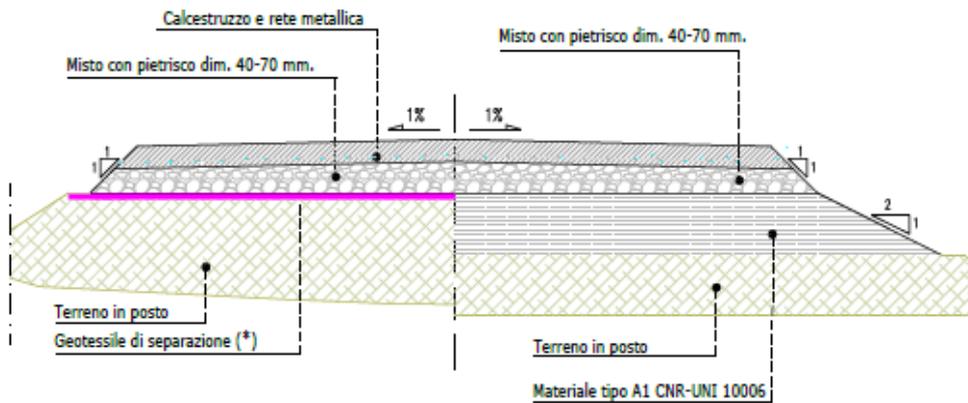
Sezione stradale tratti in rilevato ( $p > 13\%$ )
